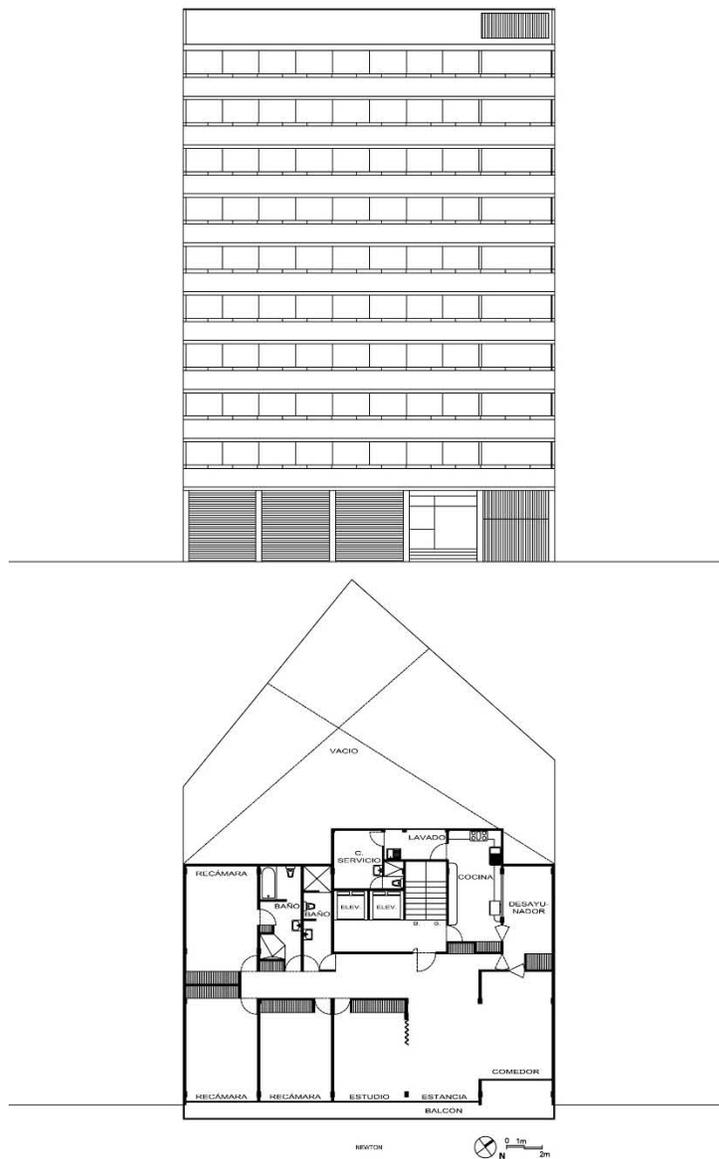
Fachada y planta del edificio ubicado en Newton núm. 156
